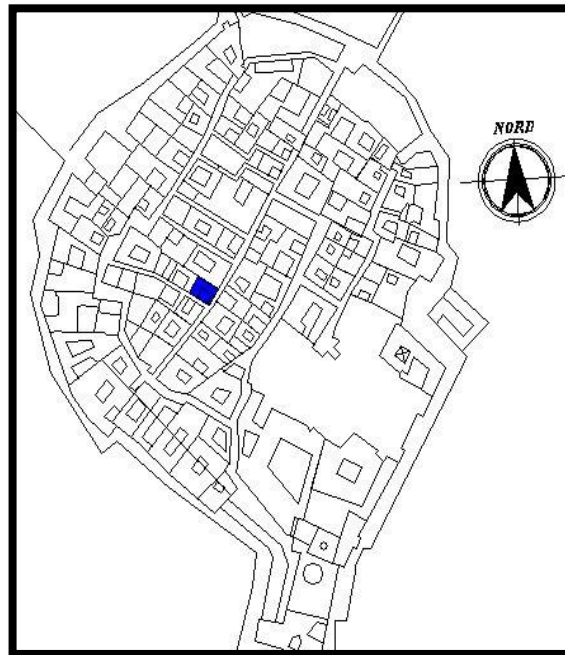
Plan de situation de maison a cour (1). (Source : par l'auteur)
